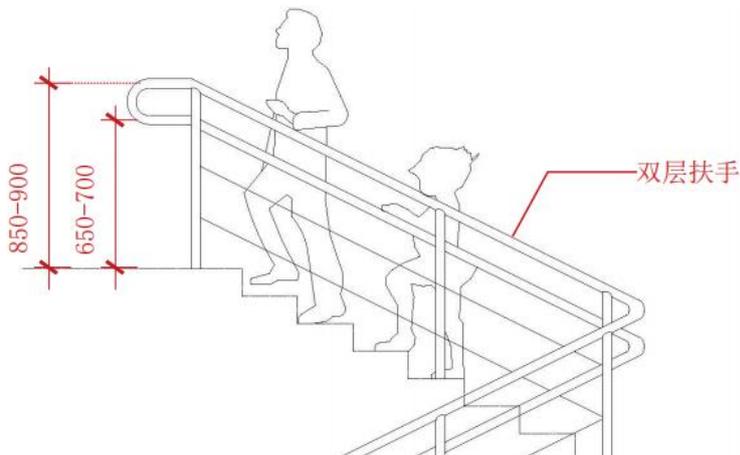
(1) 楼梯和台阶双层扶手示意图 (单位: mm)
